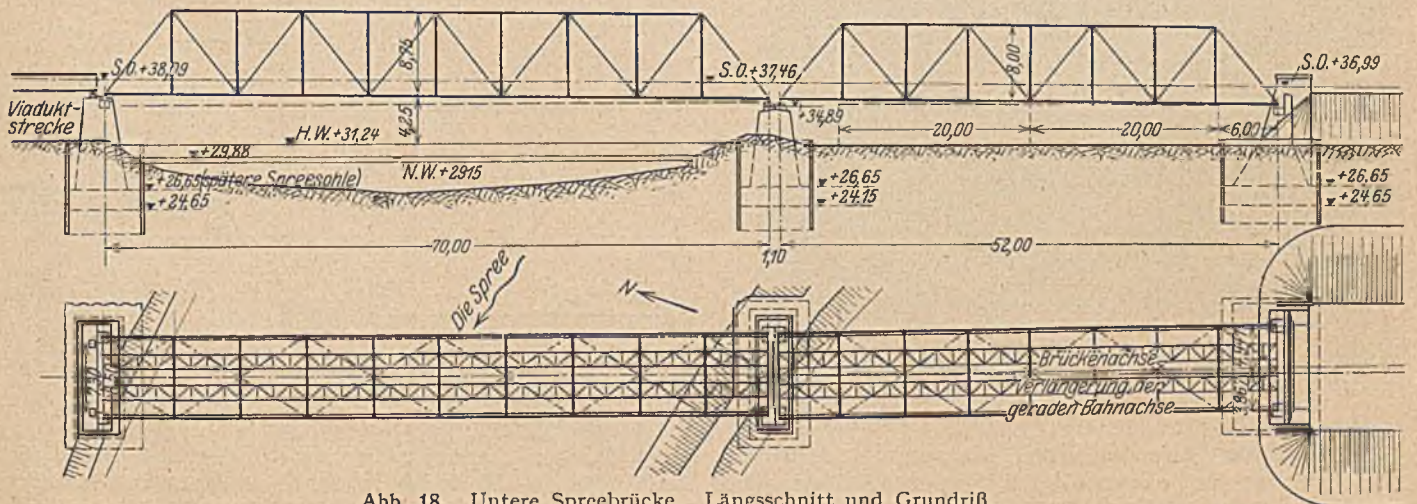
Untere Spreebrücke. Längsschnitt und Grundriß.
